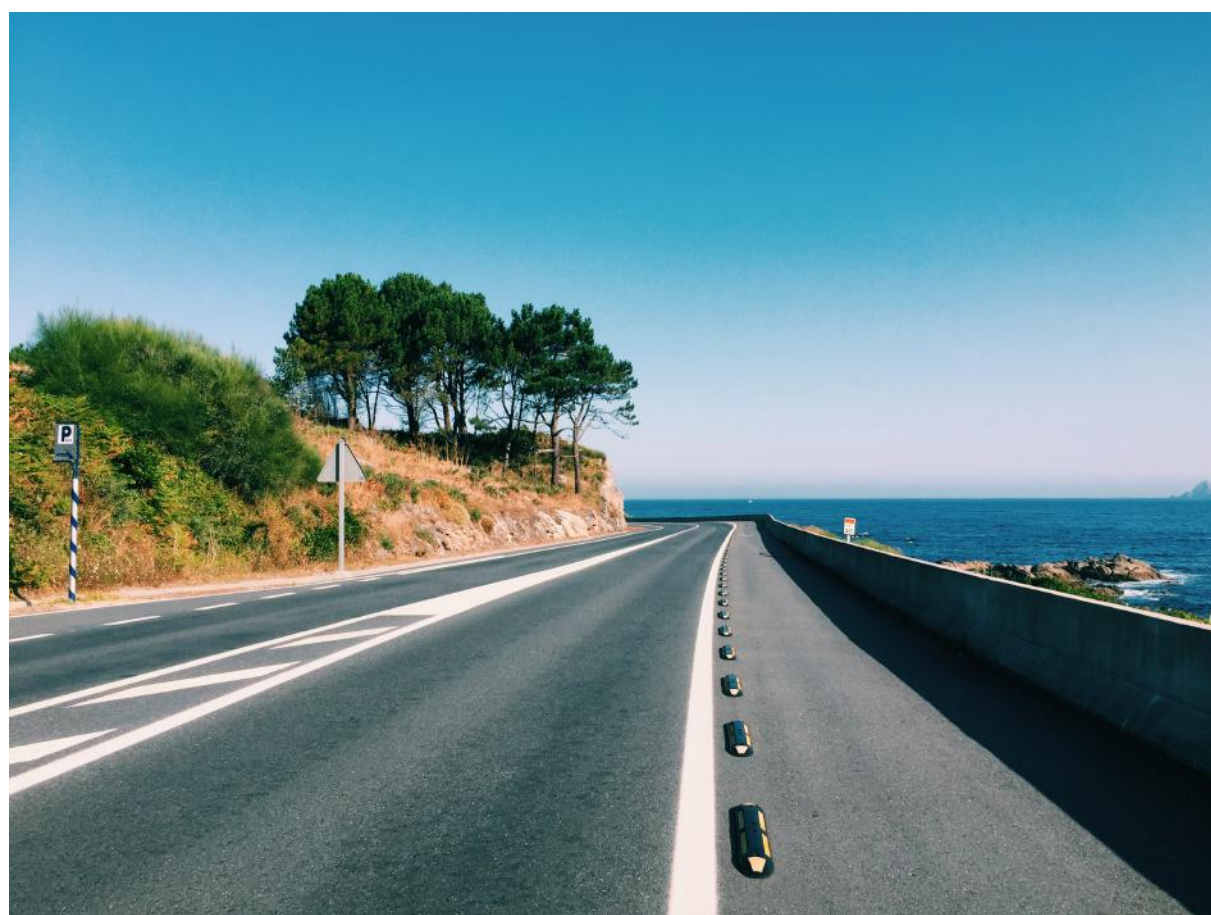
SECCIÓN TIPO ARCÉN-BICI EN LOS PRIMEROS 3 KM.
